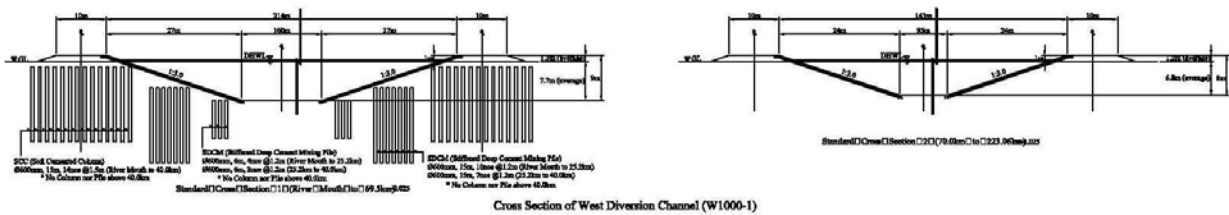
西側放水路(W1000-1)の縦断面図、断面図
